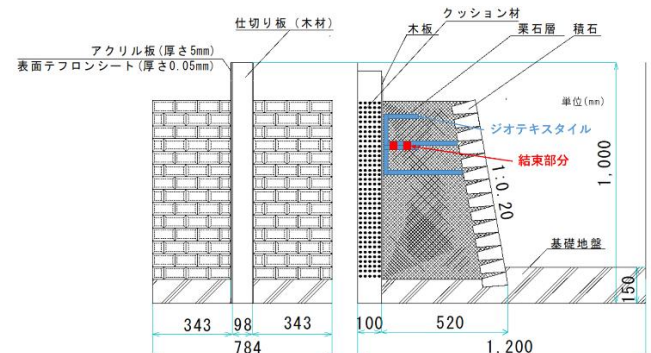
石垣模型設計及びジオテキスタイル配置図 (単位: mm)
